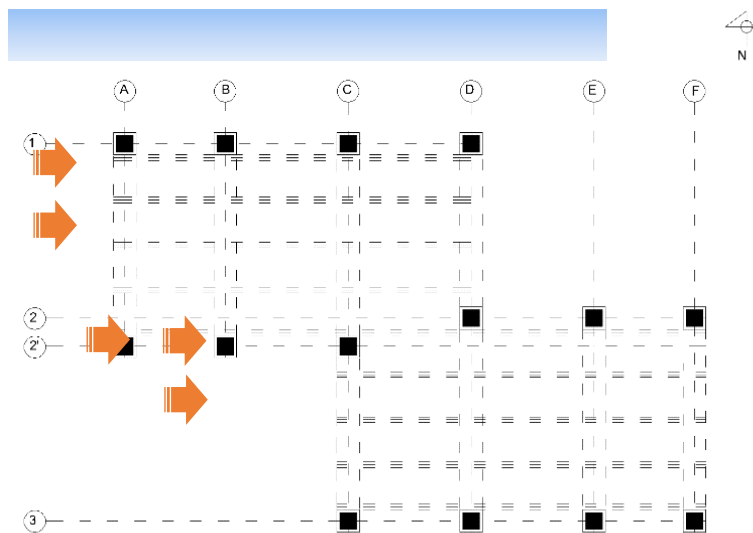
Planta estructural de palafito experimental, San Crisanto, Yucatán, México. Dibujado por Arq. Estrada.
